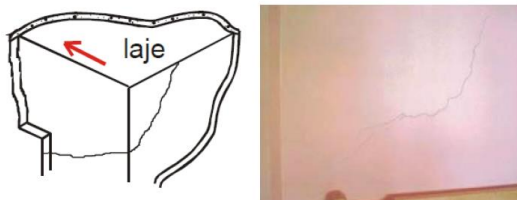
Fissuras em paredes paralelas ao sentido da deformação predominante da laje. [6]
